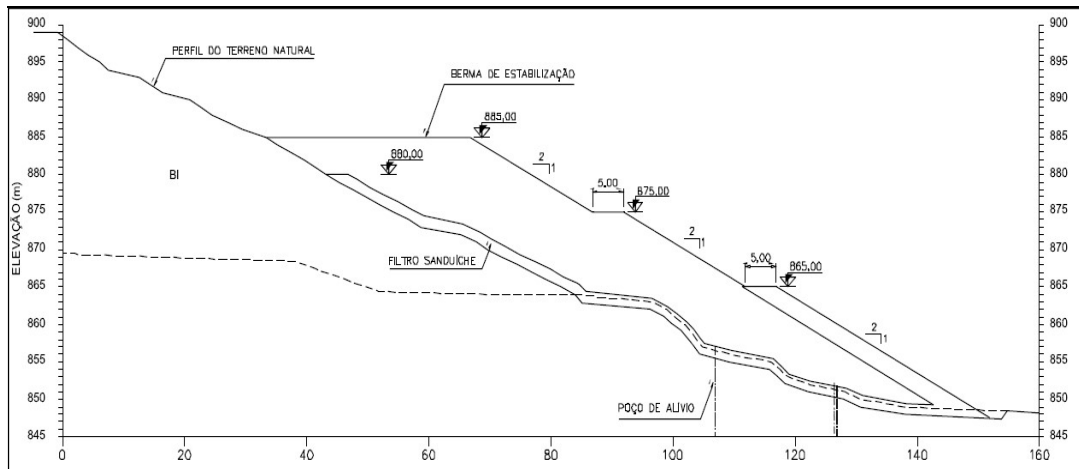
Vista em corte da berma a ser construída até a elevação 899m para estabilização da barragem B I
